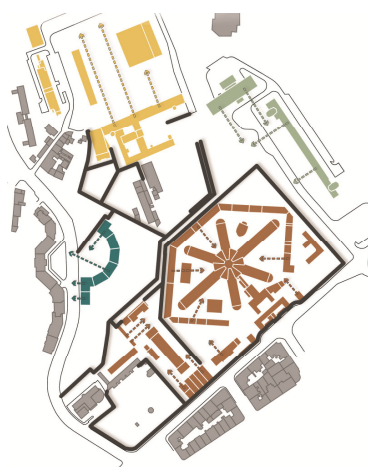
Organização do edificado existente, orientado sobre si próprio
